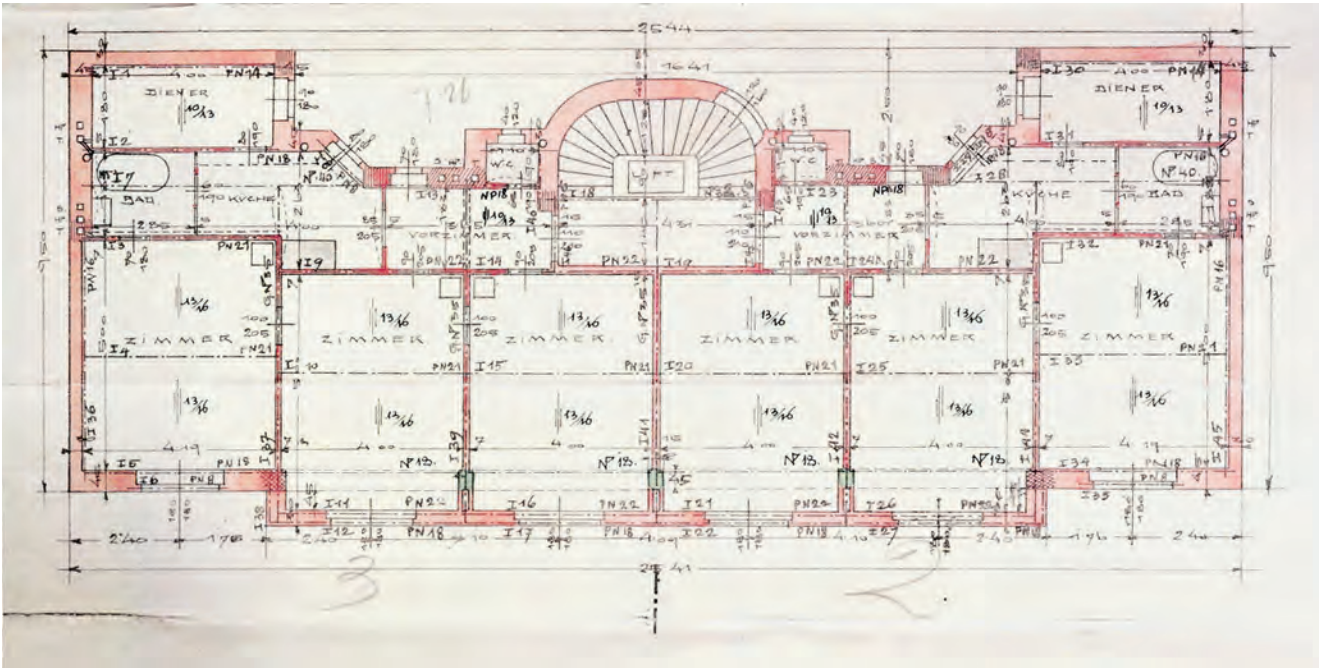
Hugo Gorge, Haus Laimgrubengasse 4, Grundriss erster Stock
